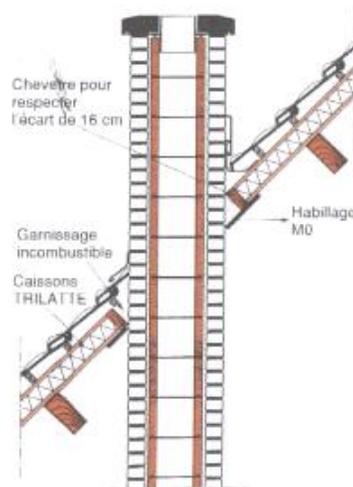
Détail de traversée de toit par un conduit de fumée
